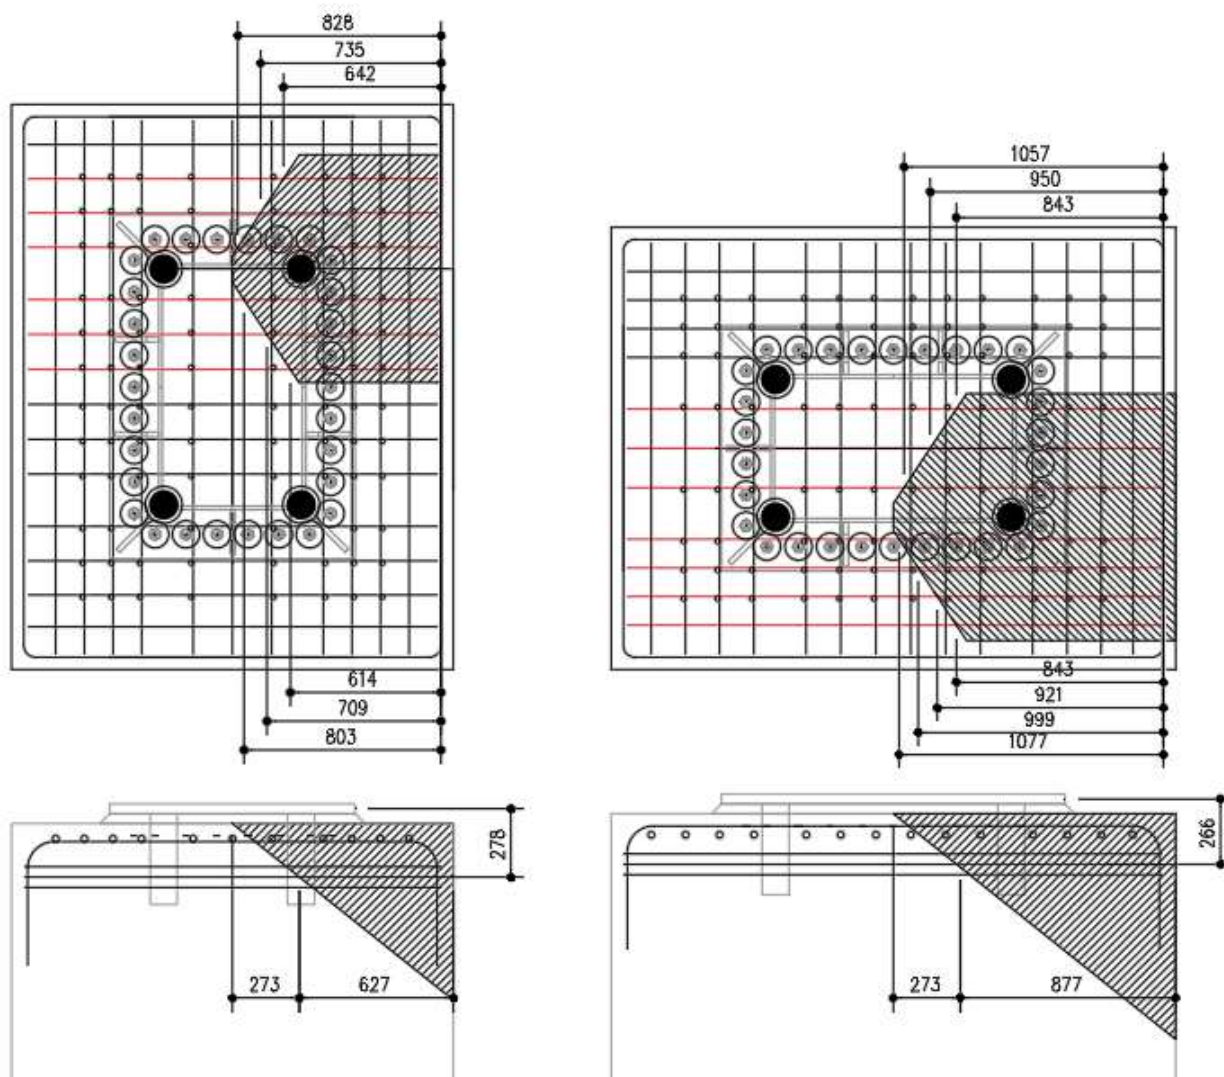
Dettaglio armatura predisposta Dir. X a sx e in direzione Y a dx
